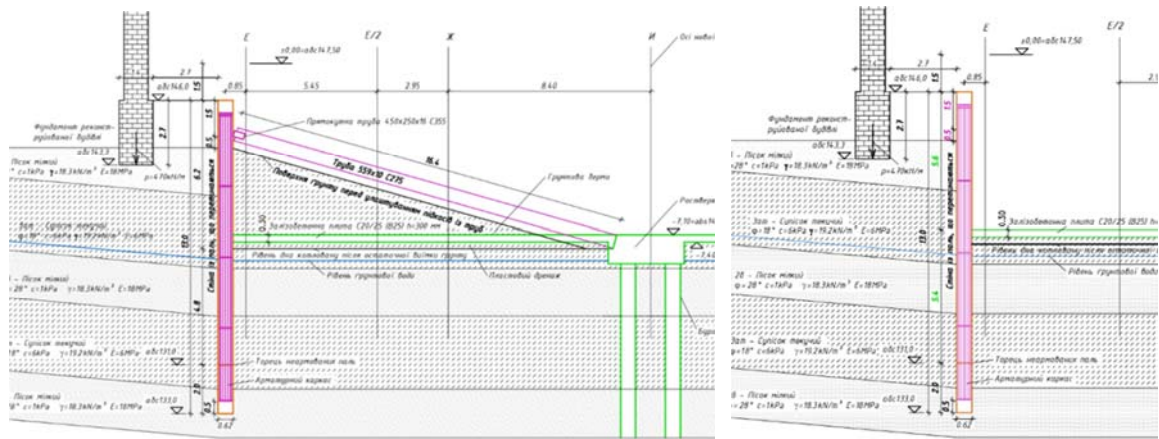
Схема огороження котловану з буросічних палей (зліва на стадії влаштування піонерного котловану; справа – на стадії підведення плити полу паркінгу)забудови
